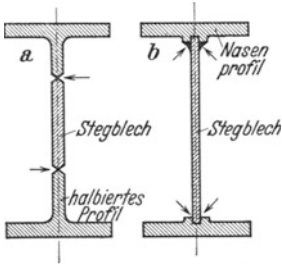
Beispiele geschweißter Trägerprofile.
